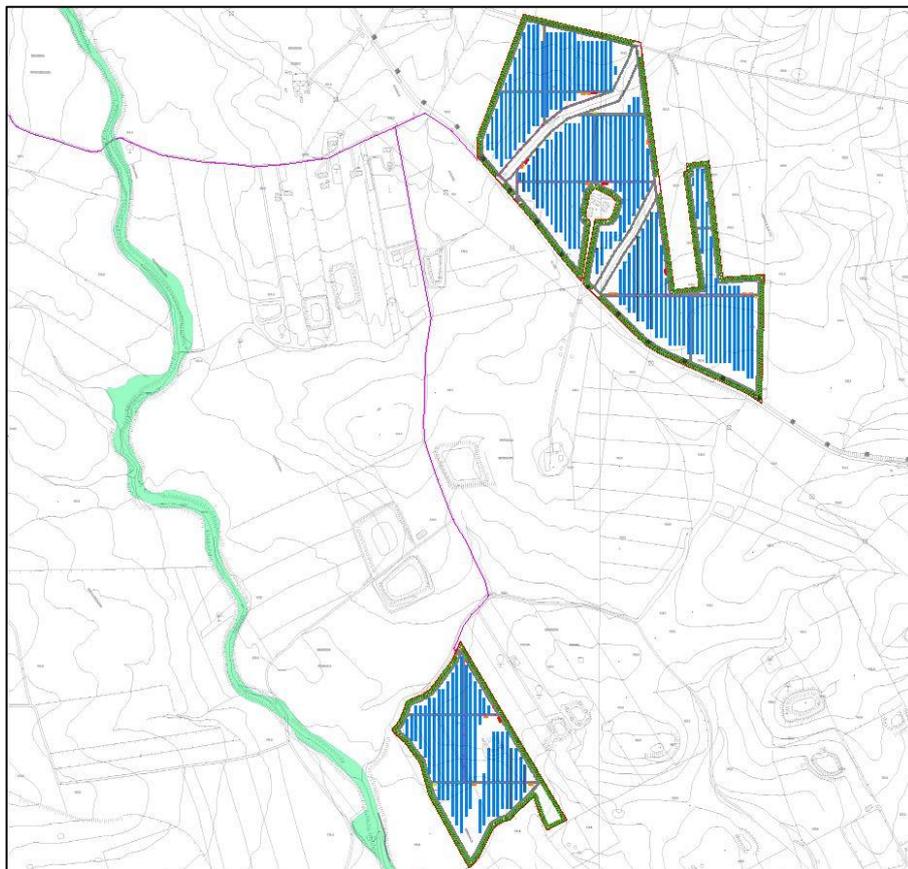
Layout di impianto rispetto all'Habitat 66220
